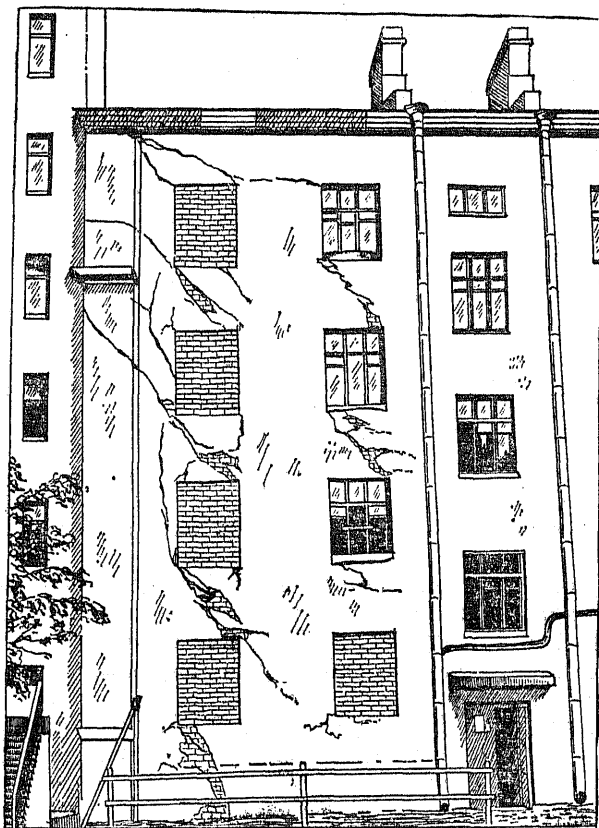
Повреждение кладки стен 4-этажного здания на ленточных фундаментах после возведения около него 11-этажного дома
